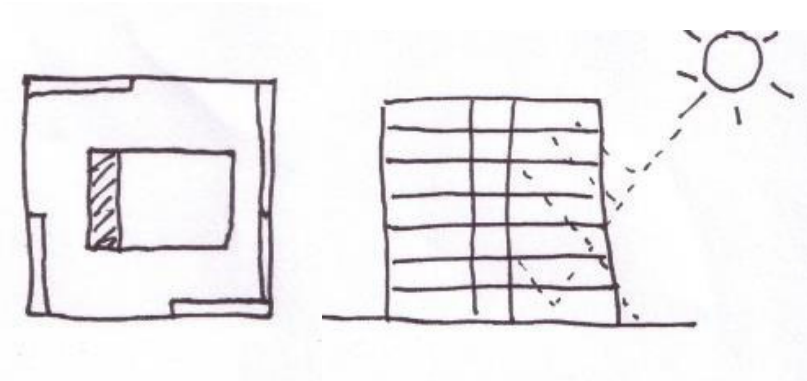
Bocetos de nueva proyección de planta por Alejandro Aravena.
